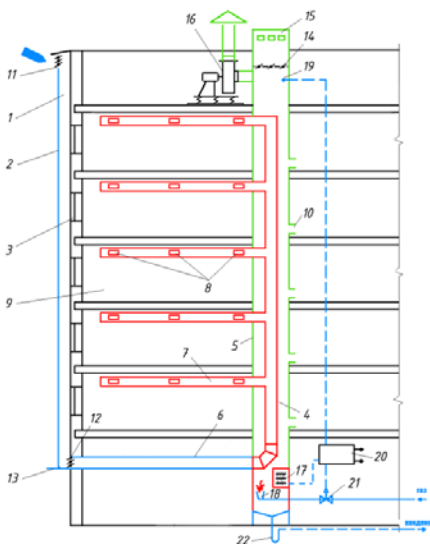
Система приточно-вытяжной вентиляции многоэтажного здания
